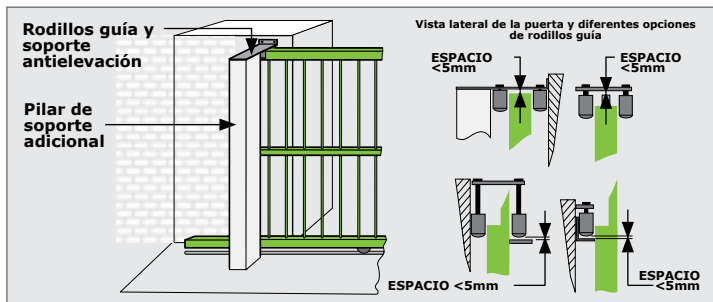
MONTAJE DE RODILLOS GUÍA
